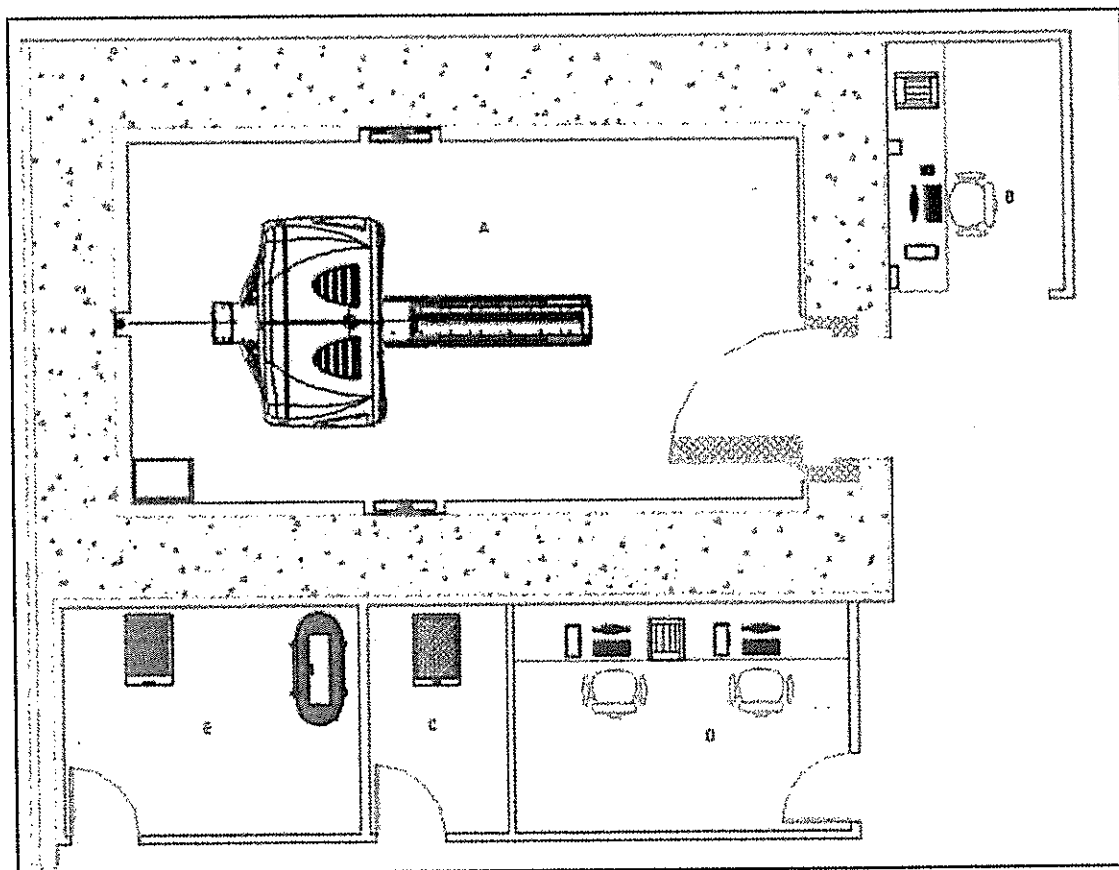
Tipico layout dell'installazione del sistema Radixact
